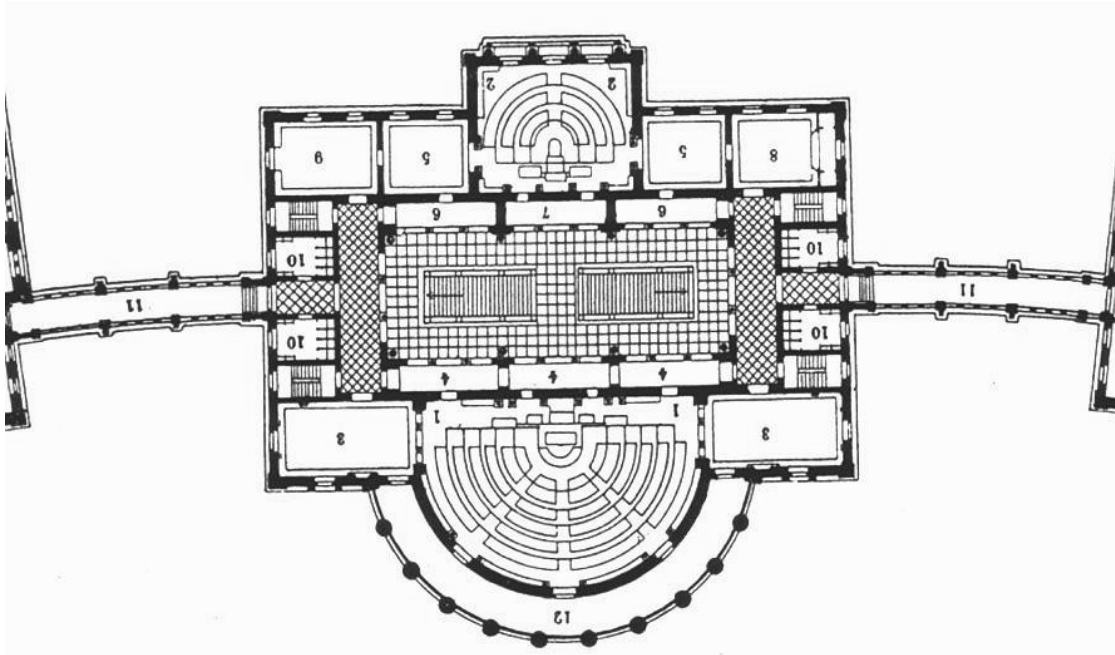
Grundriss Hauptgeschoss, Bluntschli.
